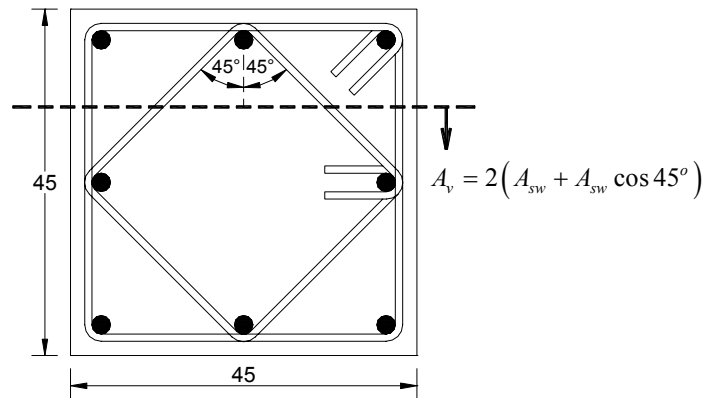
Determinación del área de refuerzo transversal A_v de la columna C45x45
